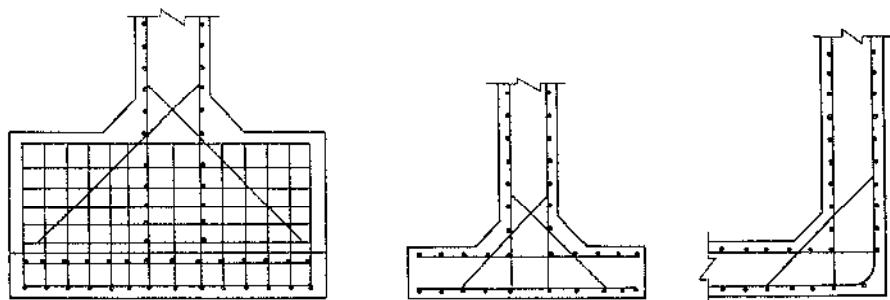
門柱と堰柱との結合部、堰柱と床版との結合部の配筋
